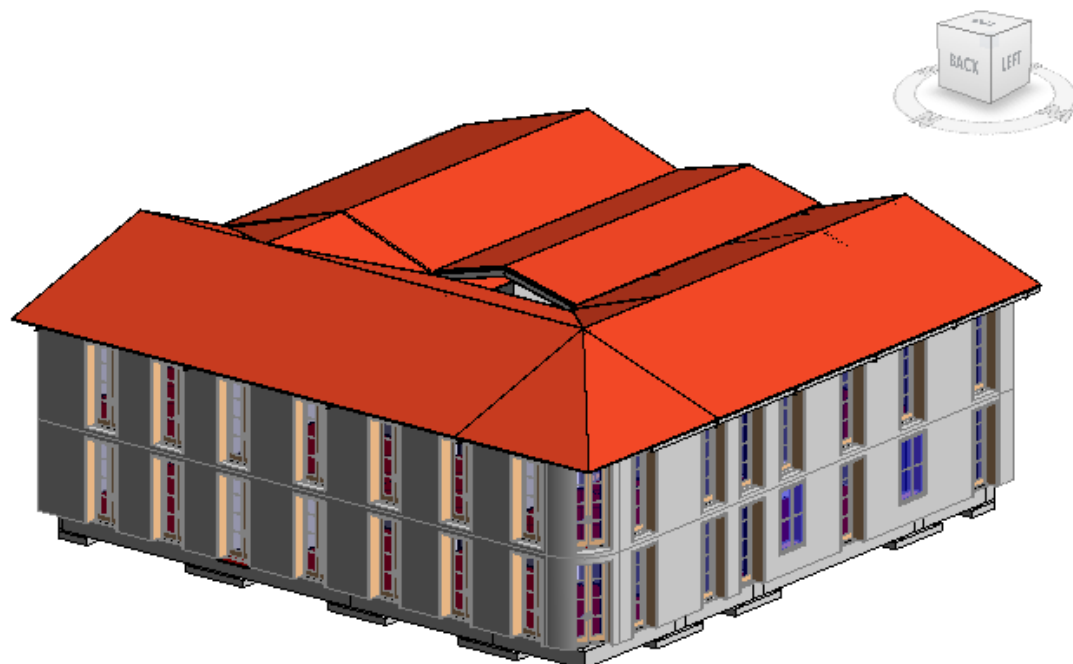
Vista 3D modelo especialidad arquitectura, elaboración propia
